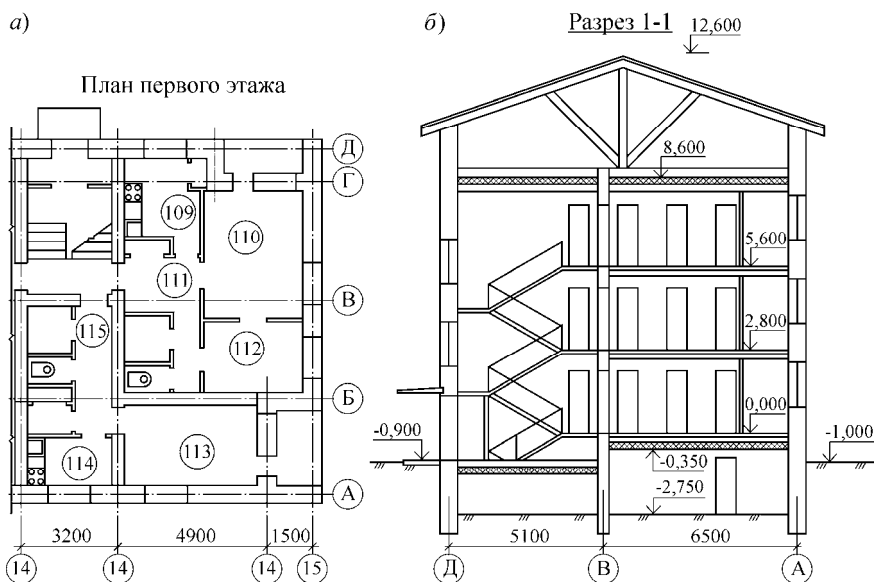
Фрагмент плана I этажа (а) и разрез (б) жилого дома
